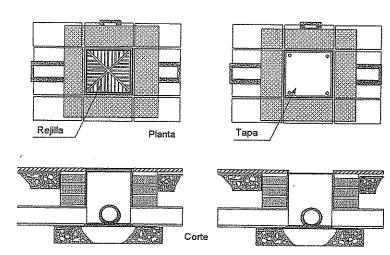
II. Detalle de pileta de piso abierta y cerrada
